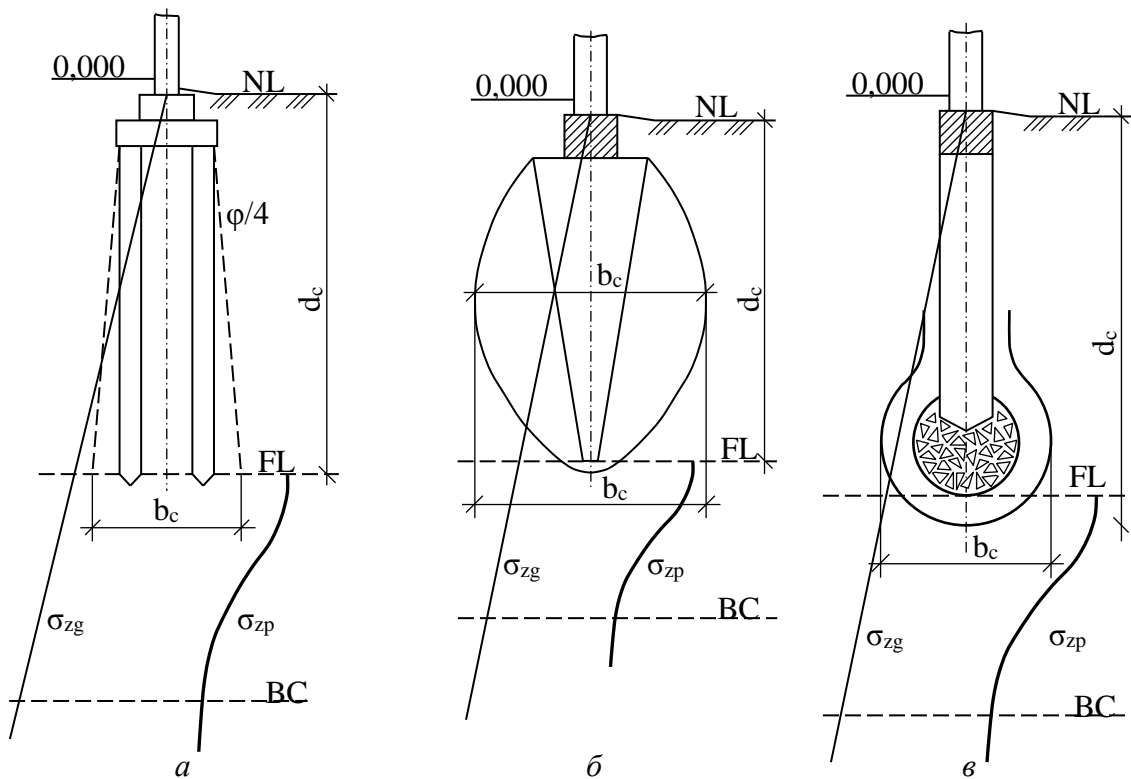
Схеми для розрахунку осідання фундаментів:
